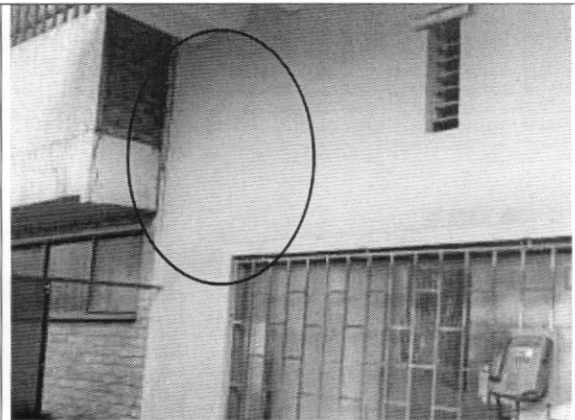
Muros de fachada del local extremo sur, fisuras en parte superior
